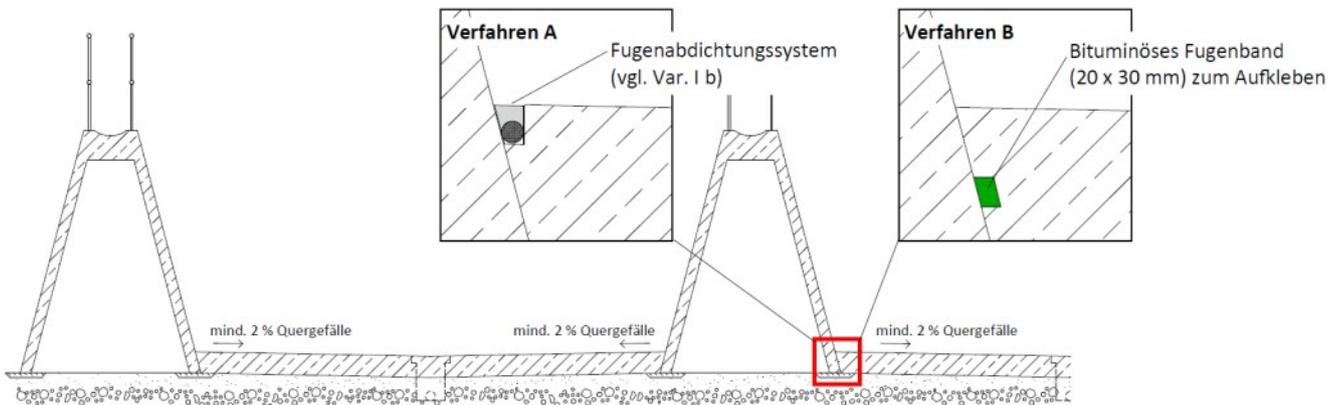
Ortbeton - Betonfertigteil (schräge Wand)
